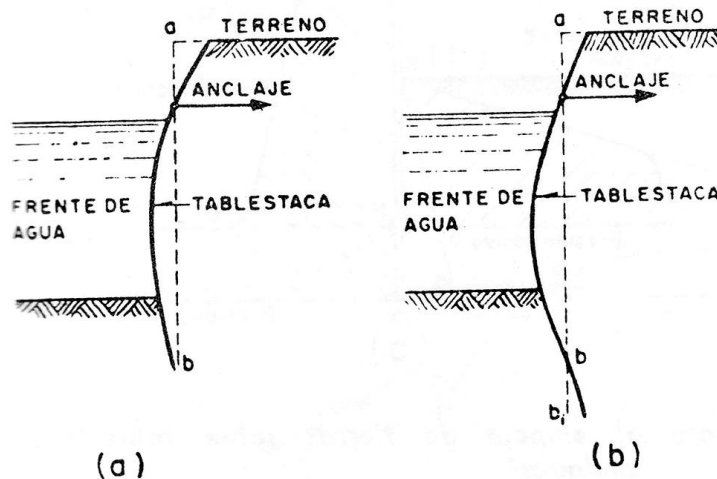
, Esquemas de tablestacas ancladas, (Ref. 2).
